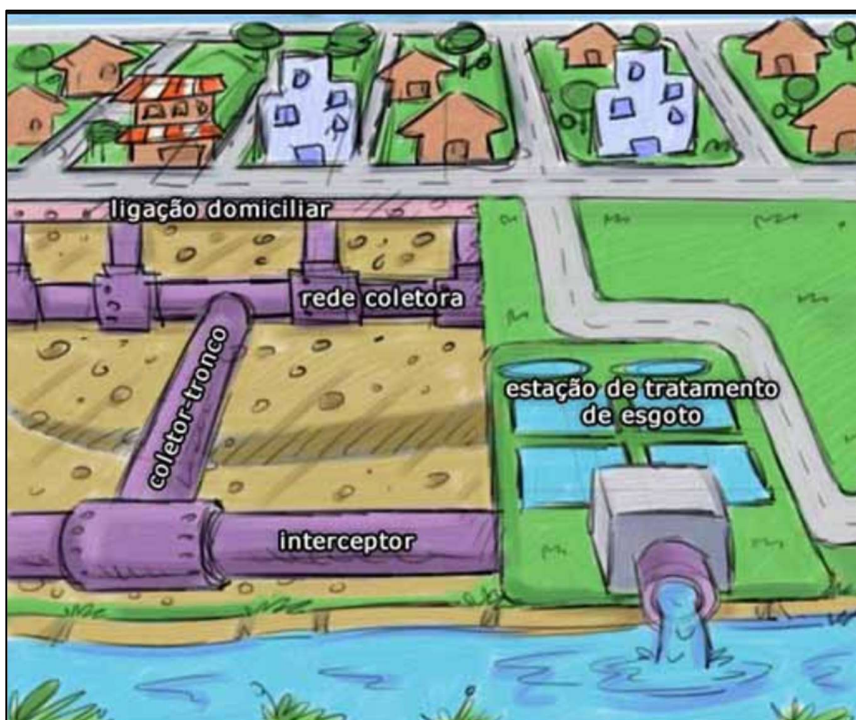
Croqui esquemático dos principais elementos do SES a ser implantado. Fonte: Sabesp.
